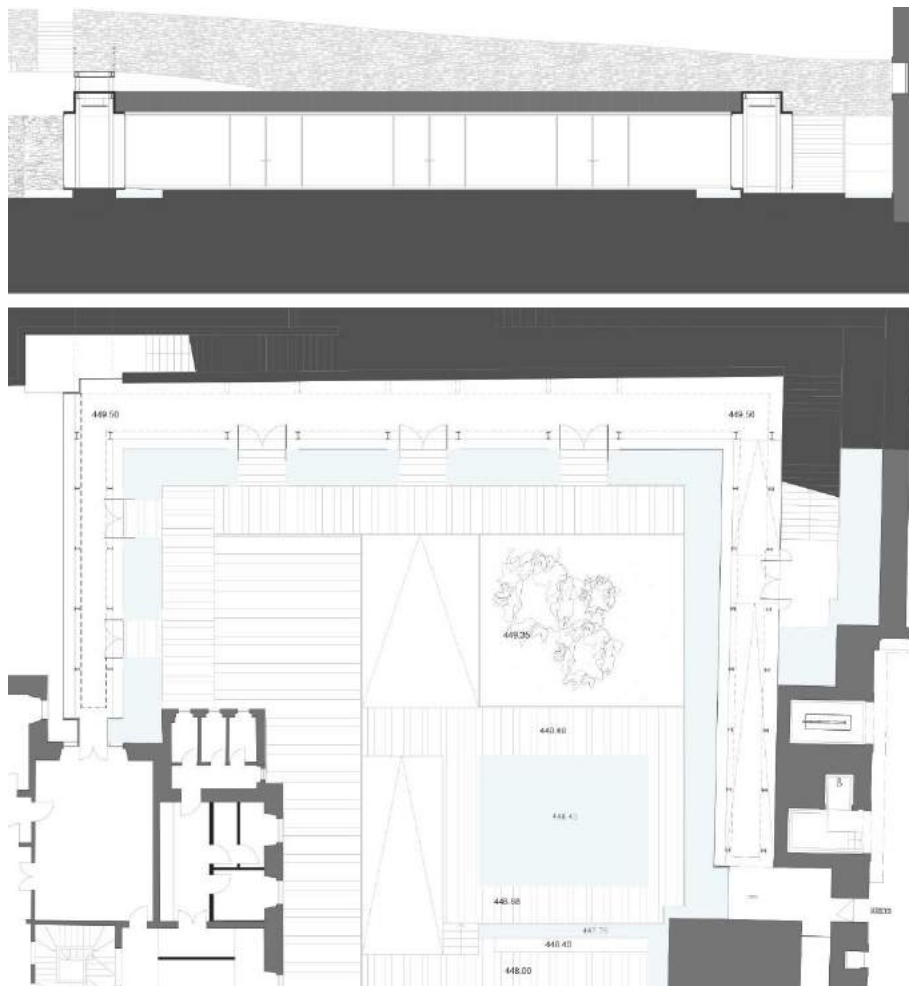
Planta e Corte Longitudinal do passadiço exterior
